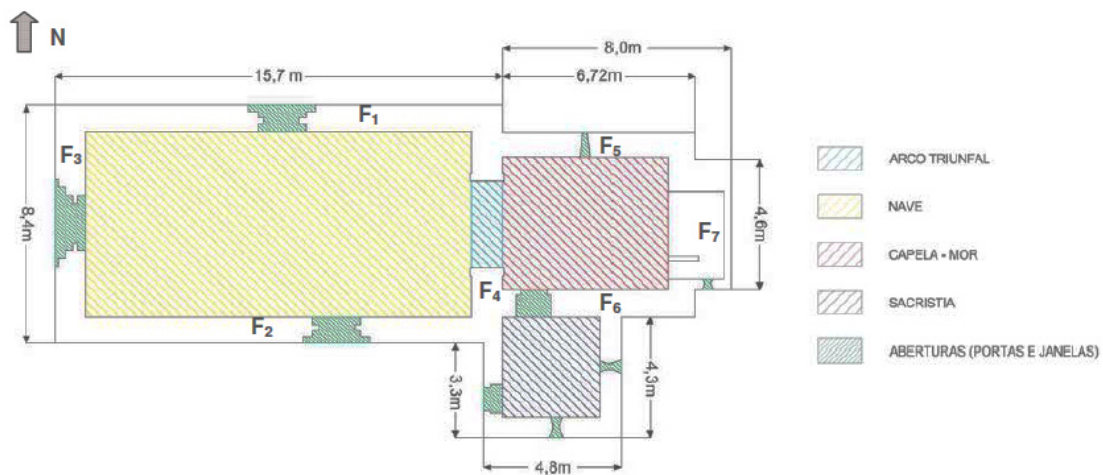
Planta arquitetónica da Igreja Velha de Gondar (Silva, 2008)
